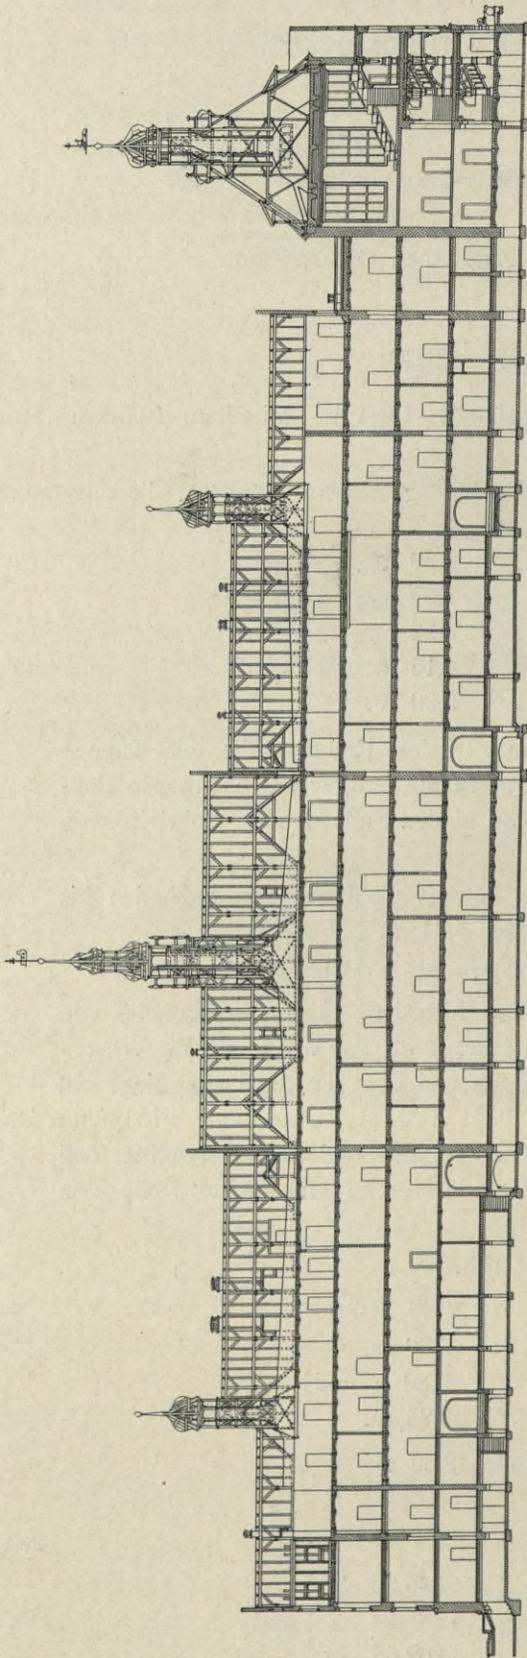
Hauptgebäude. Längenschnitt durch das Vordergebäude.
